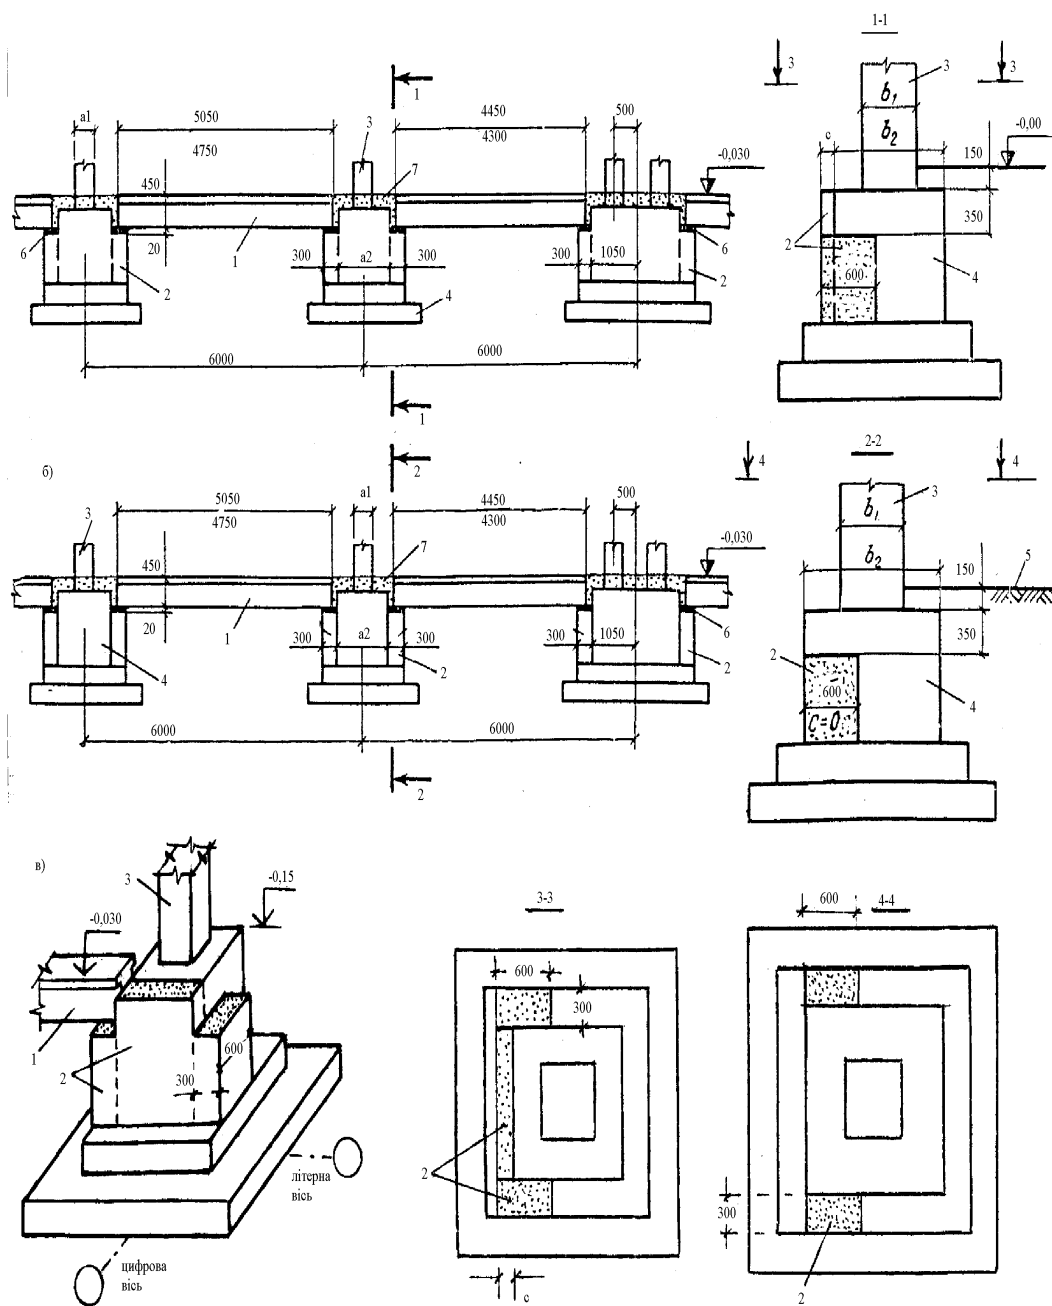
Компонування фундаментних балок: 1 – фундаментна балка; 2 – бетонний стовпчик; 3 – колона; 4 – фундамент; 5 – позначка підлоги; 6 – цементний розчин; 7 – бетон або цементний розчин.
